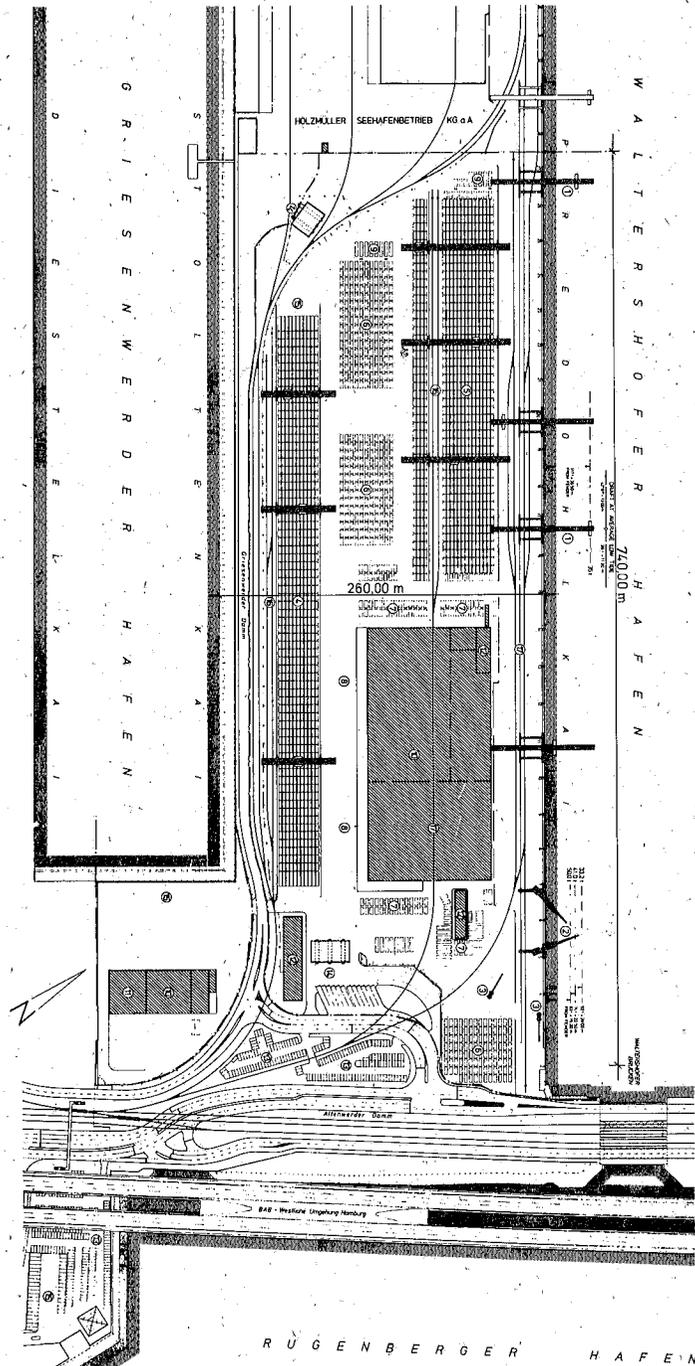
Lageplan des Euro-Kai-Container Terminal am Predöhlkai
